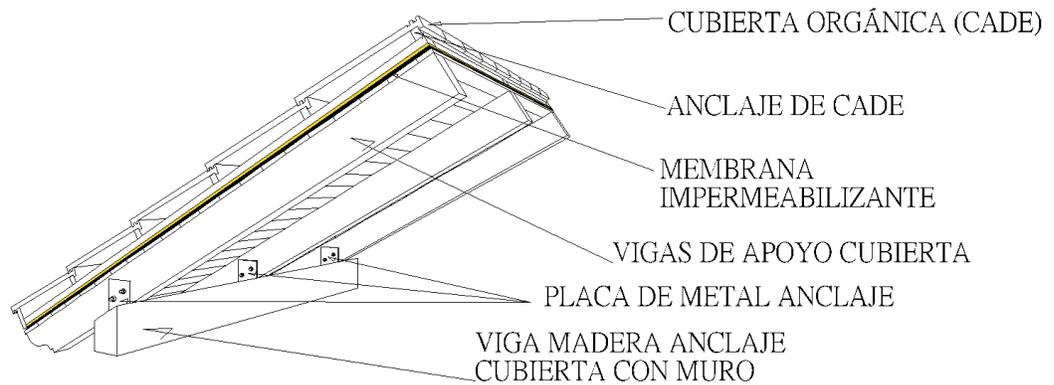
Detalle componentes y orden - Cubierta de Cade
